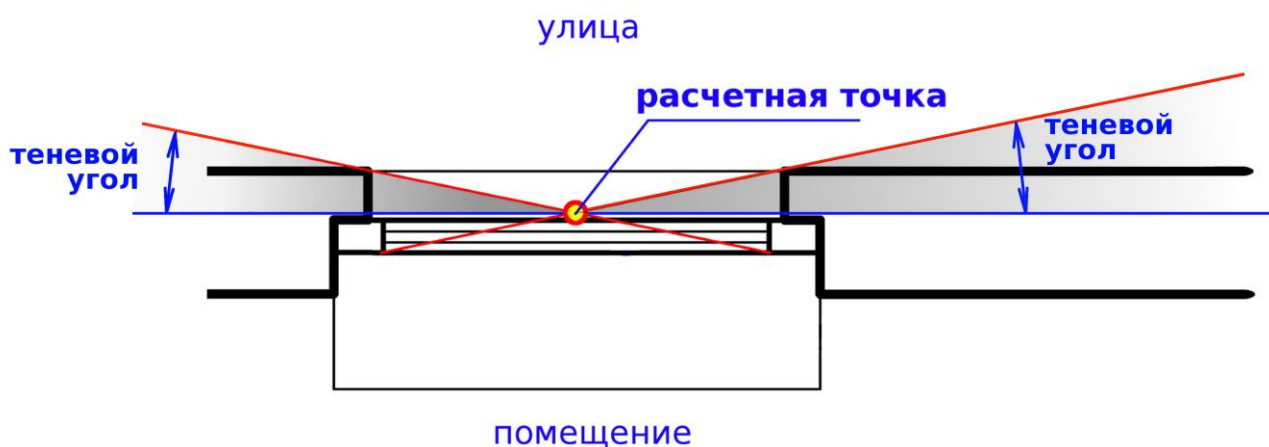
Схема построения расчетной точки и теневых углов для окна без фасадных выступов (схема плана)
